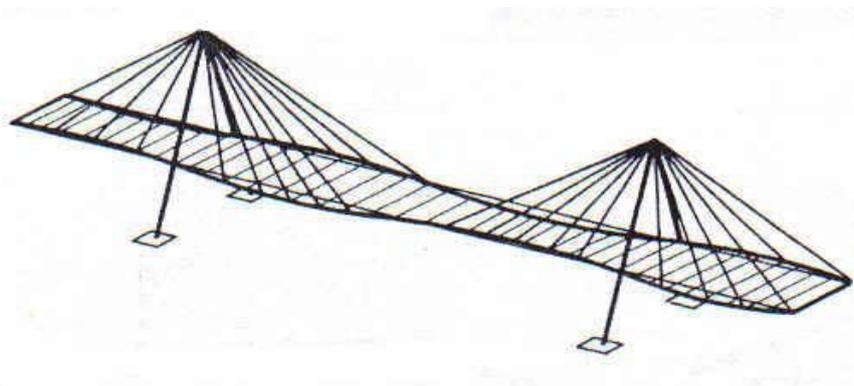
Puente atirantado con pilones en forma de A
